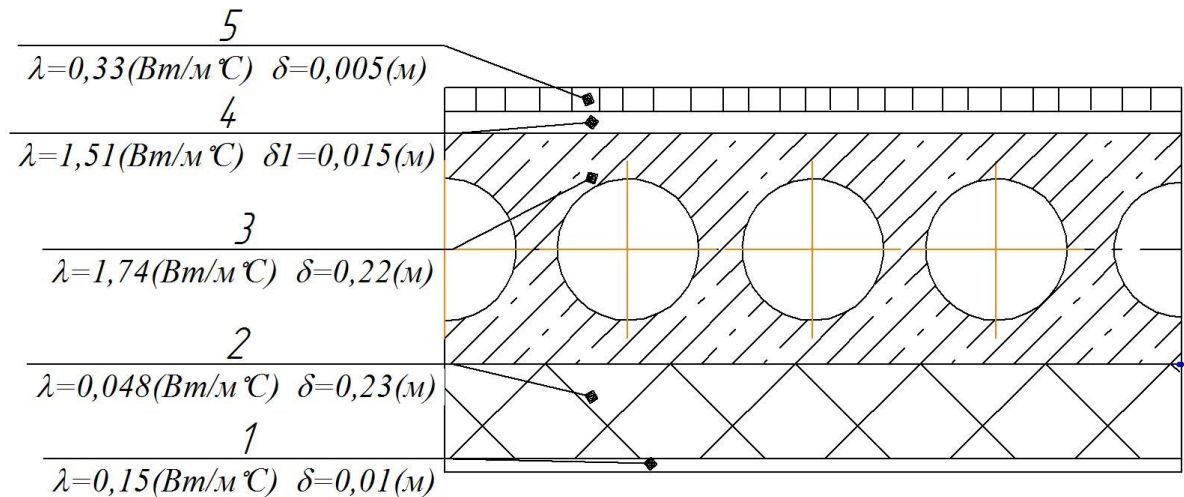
Схема утеплення перекриття: 1 - лист гіпсокартону, 2 - пластини мінервати, 3 - залізобетонна плита, 4-бетонне покриття, 5–лінолеум [2].
